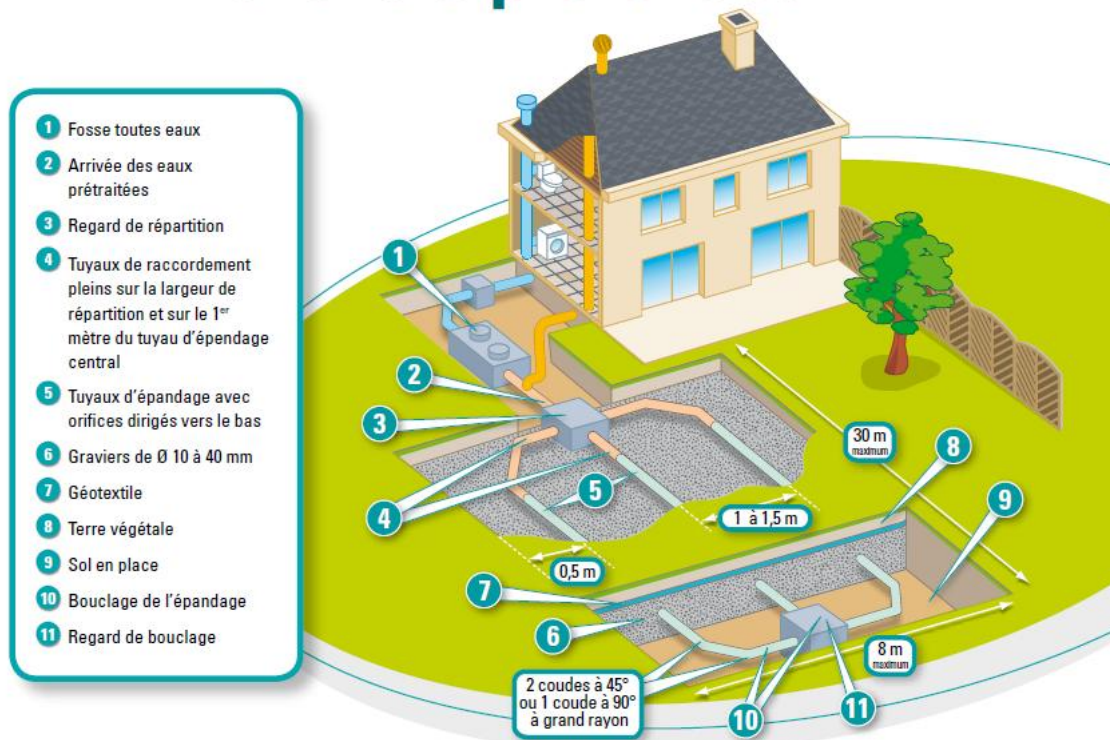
Schéma d'un dispositif d'assainissement non collectif (source : la CAPEB)
